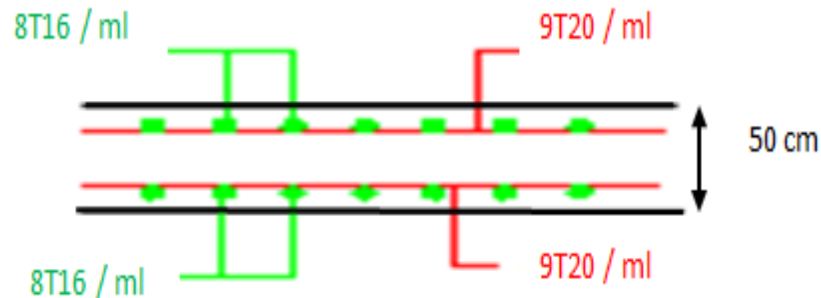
Ferrailages longitudinales du radier (coupe-XX).
